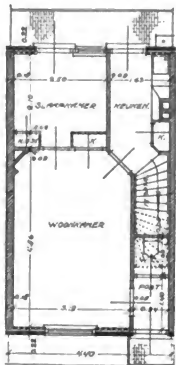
Grundriß zu Abb. 161, Reihenwohnung, Erdgeschoss.
